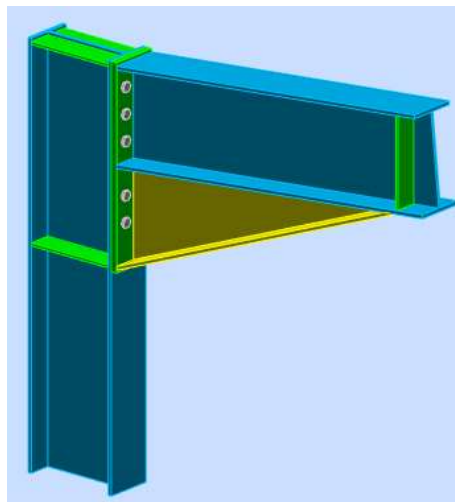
Vue 3D pour Assemblage poteau-traverse.
